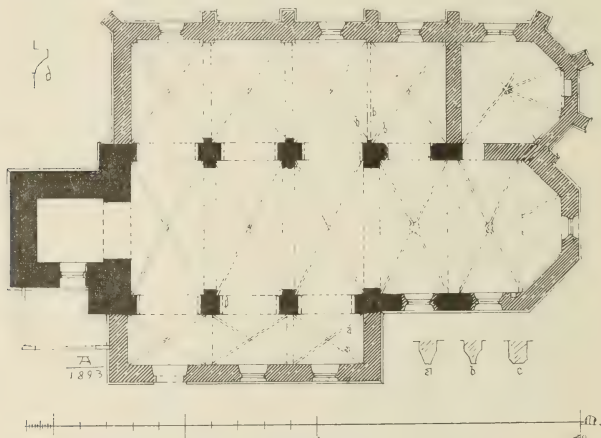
Thor. Grundriss der alten katholischen Pfarrkirche.
